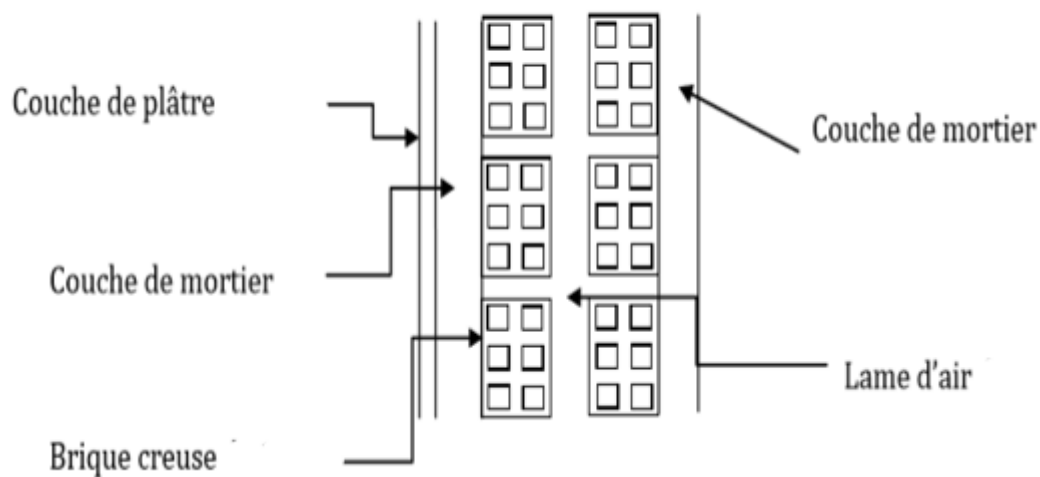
Coupe transversal d'un mur double parois en brique creuse.
